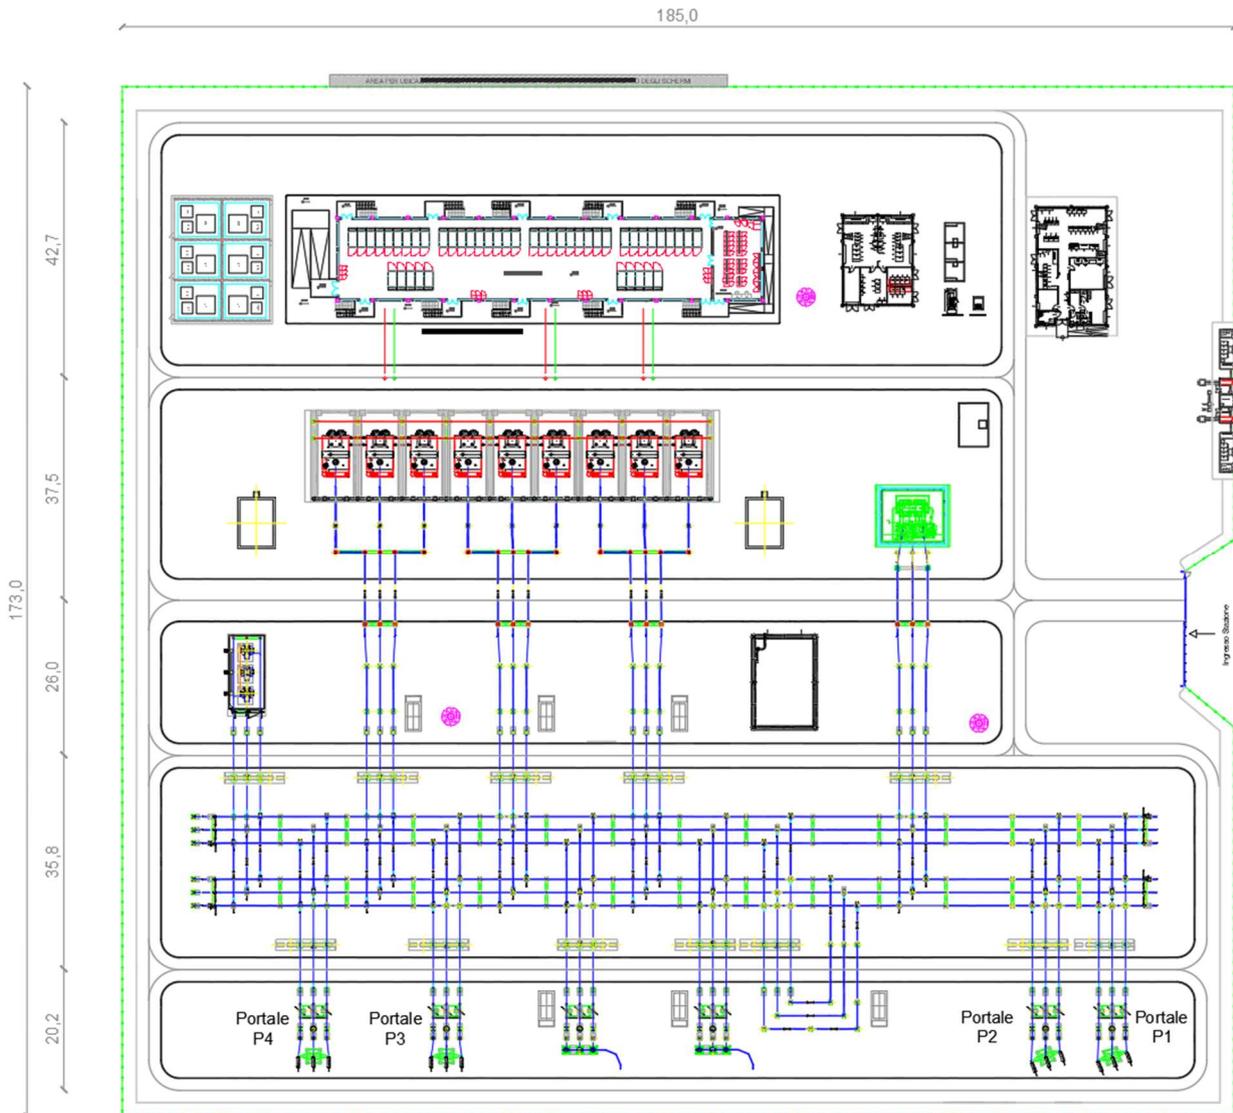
Planimetria elettromeccanica futura SE RTN 150/36 kV
